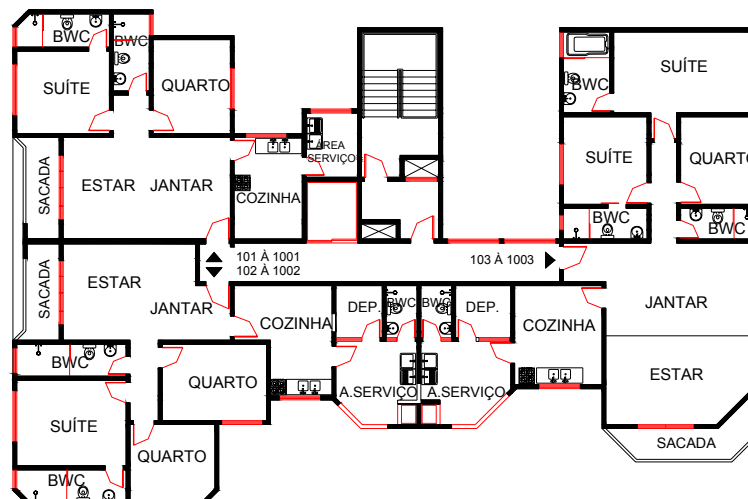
Planta Baixa do pavimento tipo do estudo de caso B.
